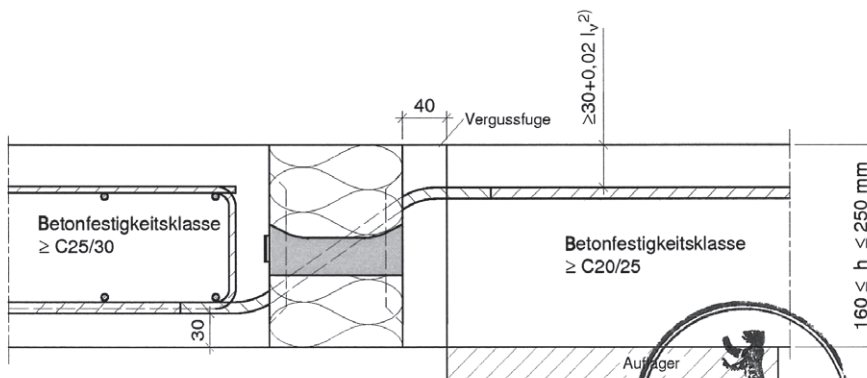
Beispiel Schöck Isokorb Typ RQ-240 in eingebautem Zustand mit Vergussfuge
